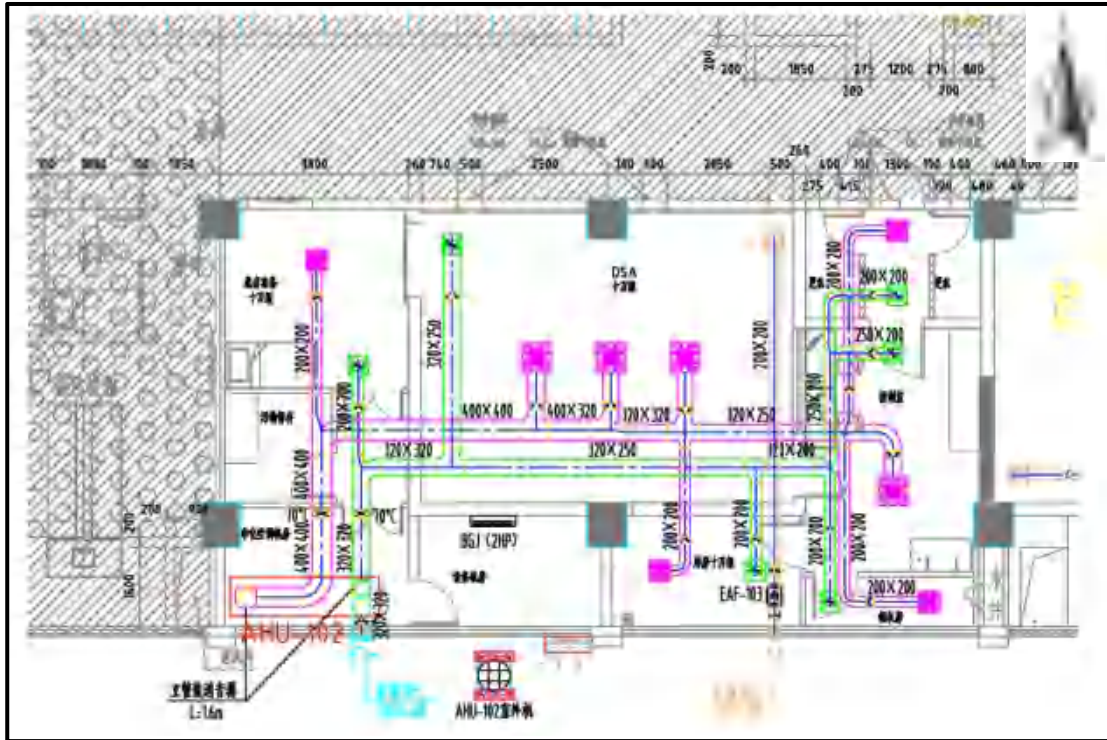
急诊外科楼一层DSA介入室风管总平面图
